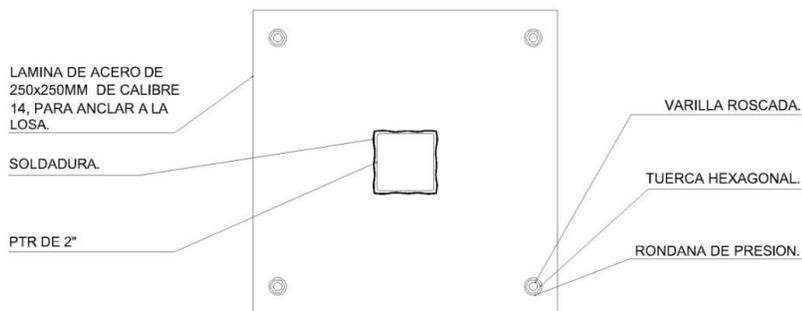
Ejemplo 2 de refuerzo en muros de tablaroca para soporte de pantalla.
